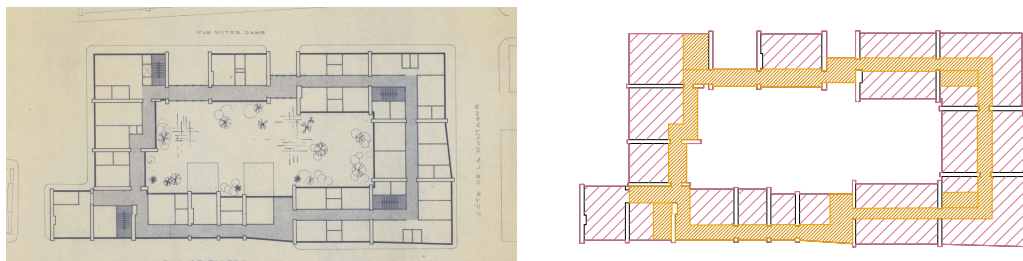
Plan du projet de la construction de l'hôtel Hilton.
